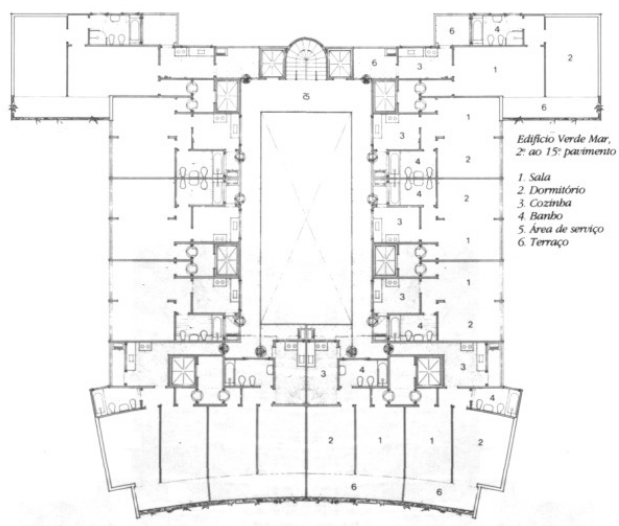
Planta do pavimento tipo. Fonte: Revista AU nº26, v.5, out./nov. 1989, p. 85.
